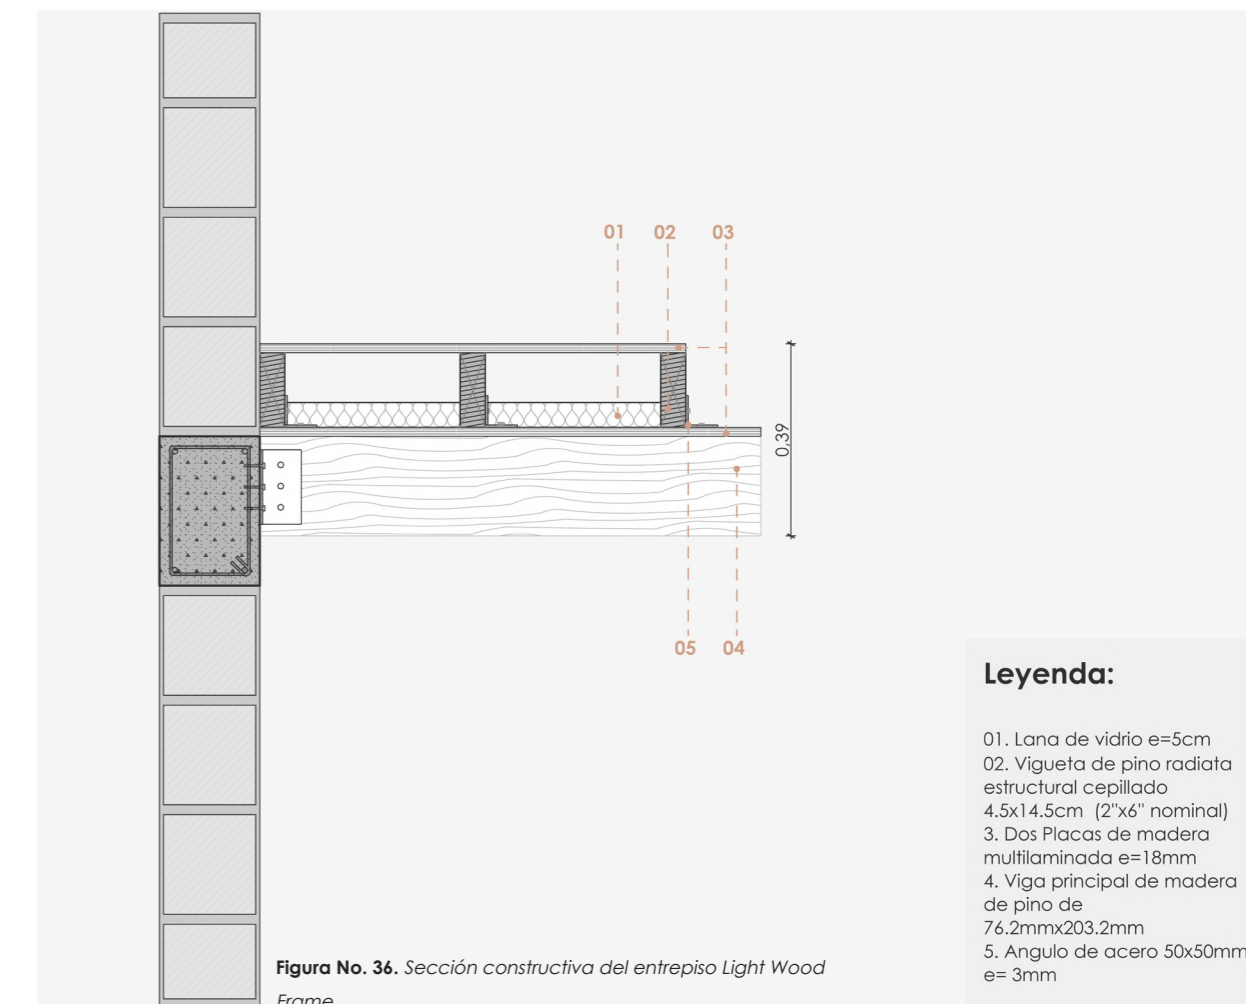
Sección constructiva del entrepiso Light Wood Frame
